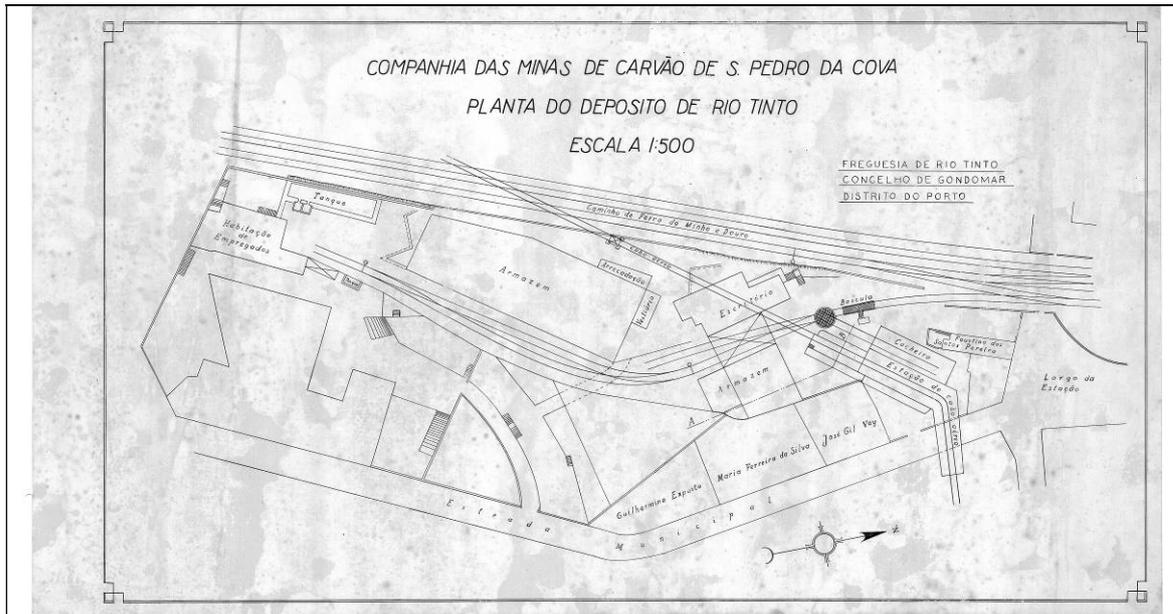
Planta do depósito de Rio Tinto, à escala 1:500
